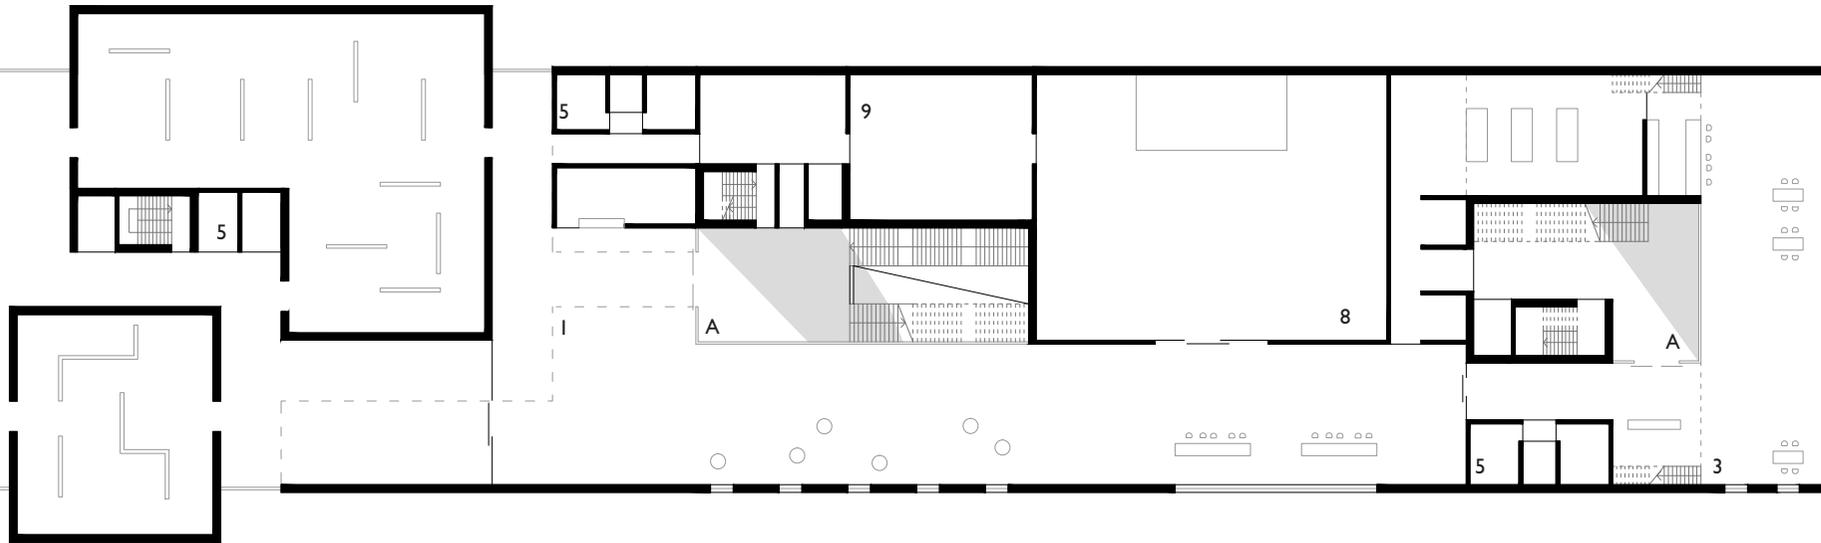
GRUNDRISS ERDGESCHOSS | 1000
